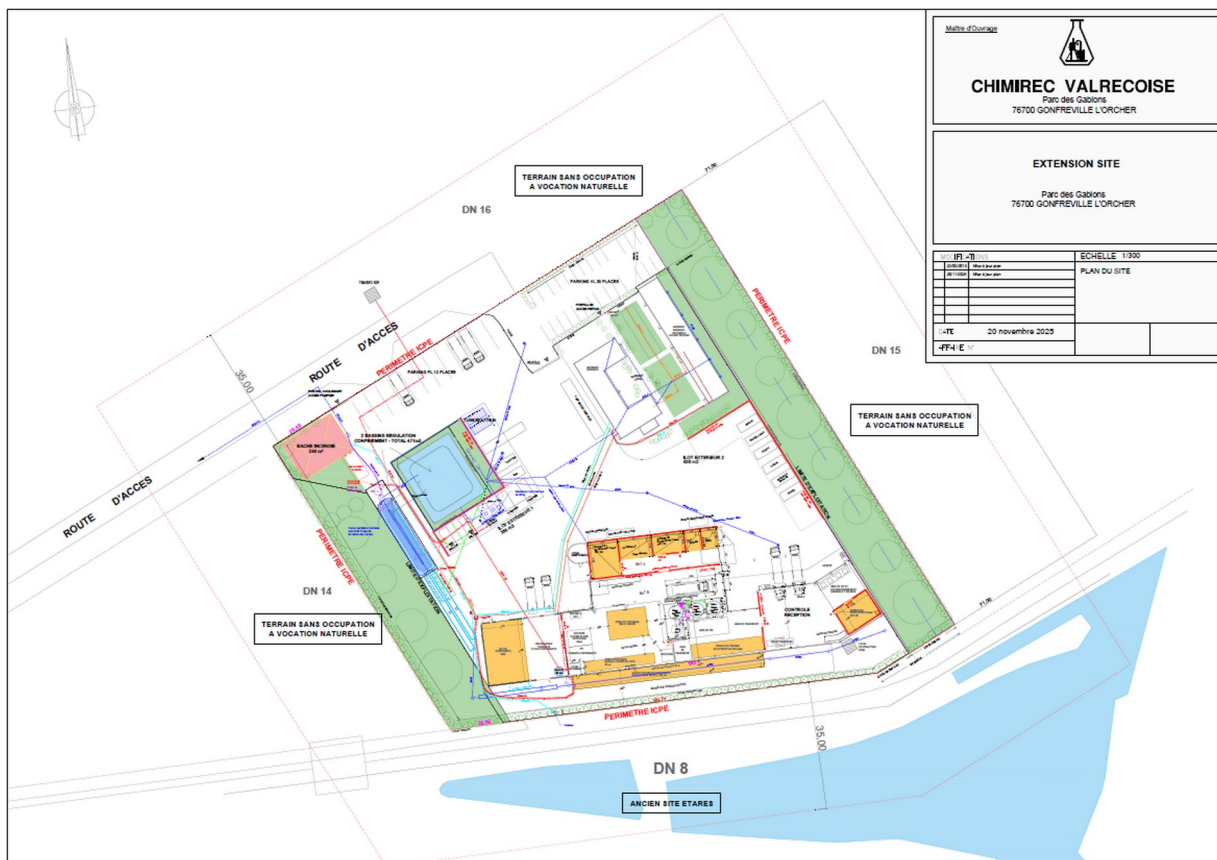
plan de masse du site à l'état projet (source : carte PJ 48).
